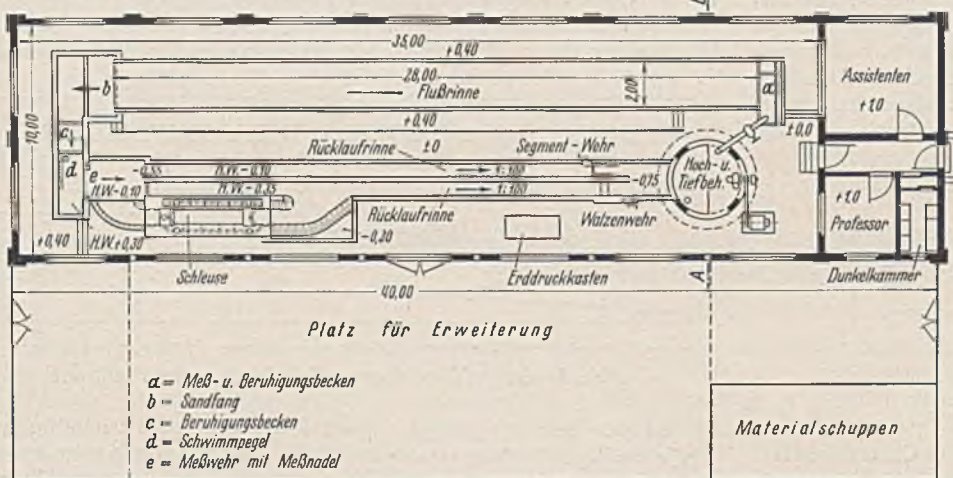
Grundriß des Wasserbaulaboratoriums in Woosung.
